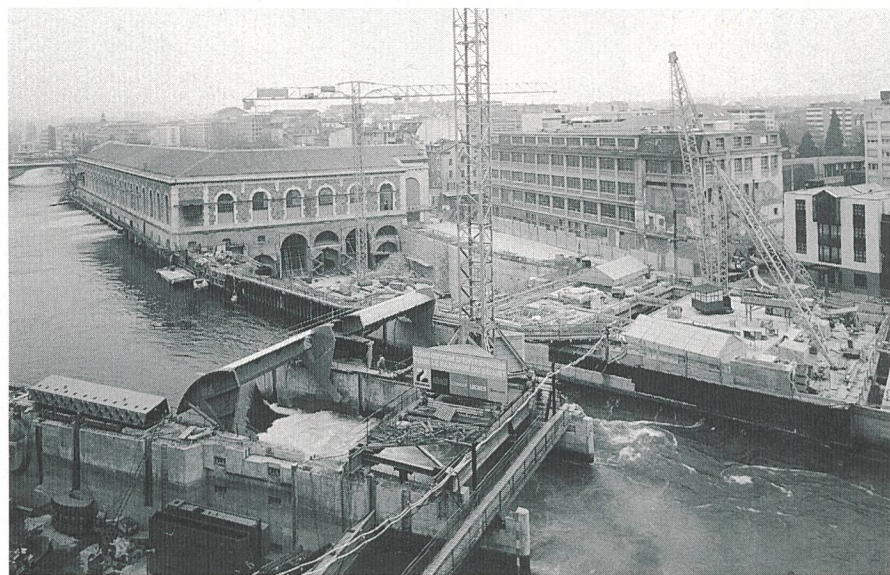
Chantier de construction de la centrale, Le Seujet, située sur le Rhône. On reconnaît en haut à gauche l'usine historique, La Coulouvrenière
